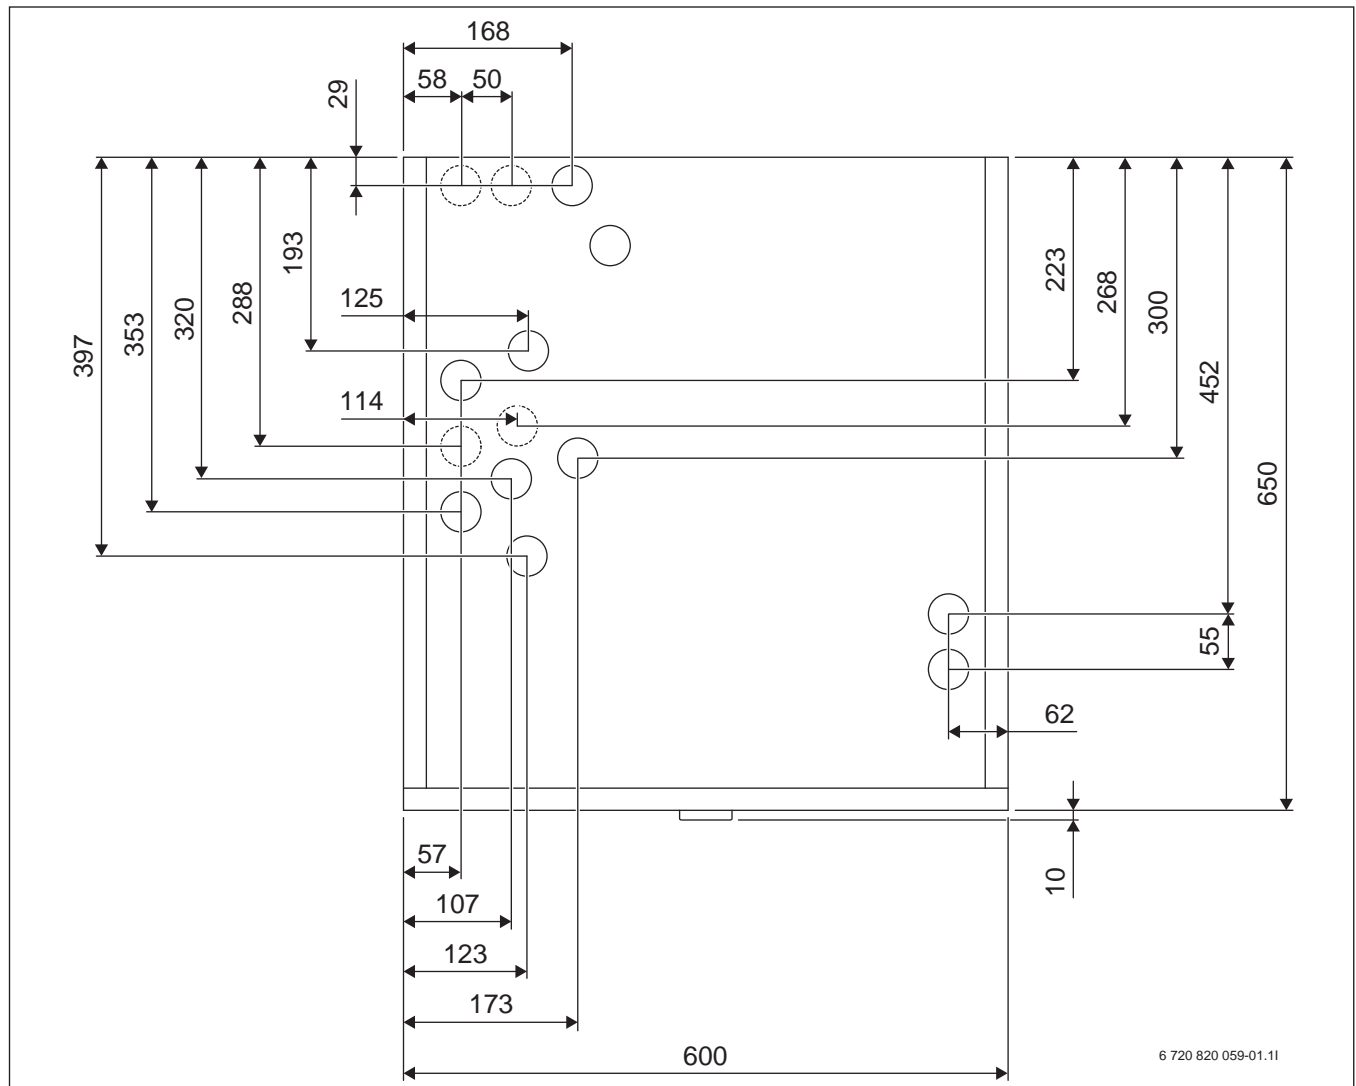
Anschlussabmessungen, Draufsicht (Maße in mm)
